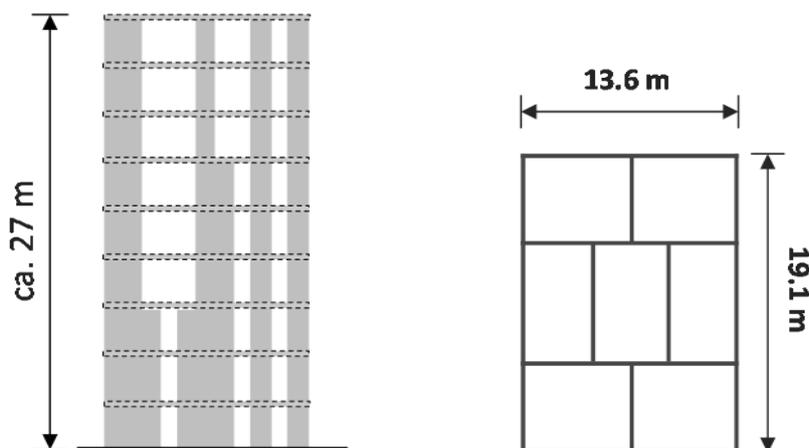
Dimensions de la structure et représentation schématique des parois et des ouvertures
